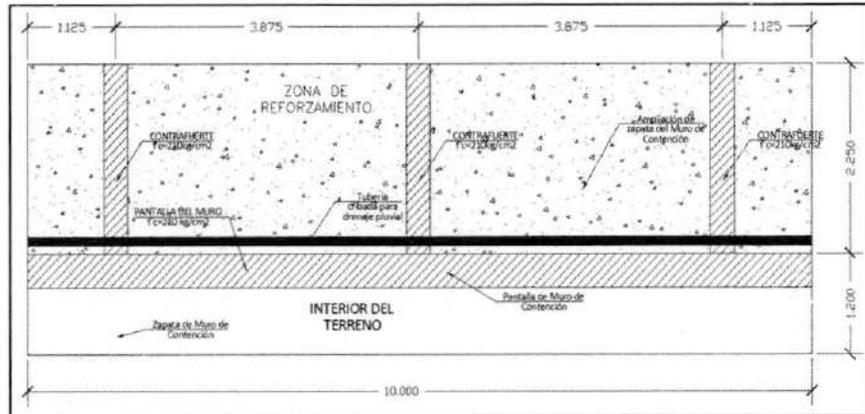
Vista en planta de la propuesta técnica se aprecia la ampliación de la zapata y la inclusión de contrafuertes, el relleno con material granular de préstamo para un paño de muro de contención.
